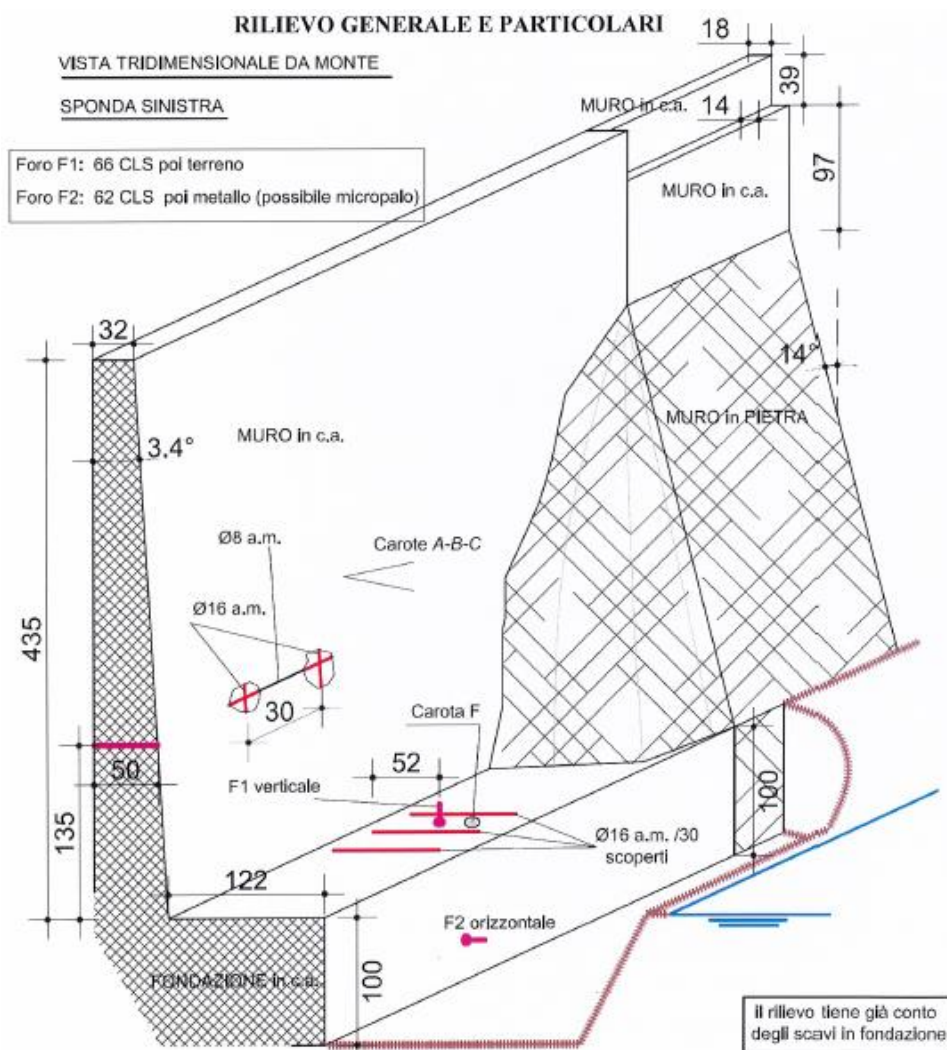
Sezione tipologica strutturale rilevata in sito
